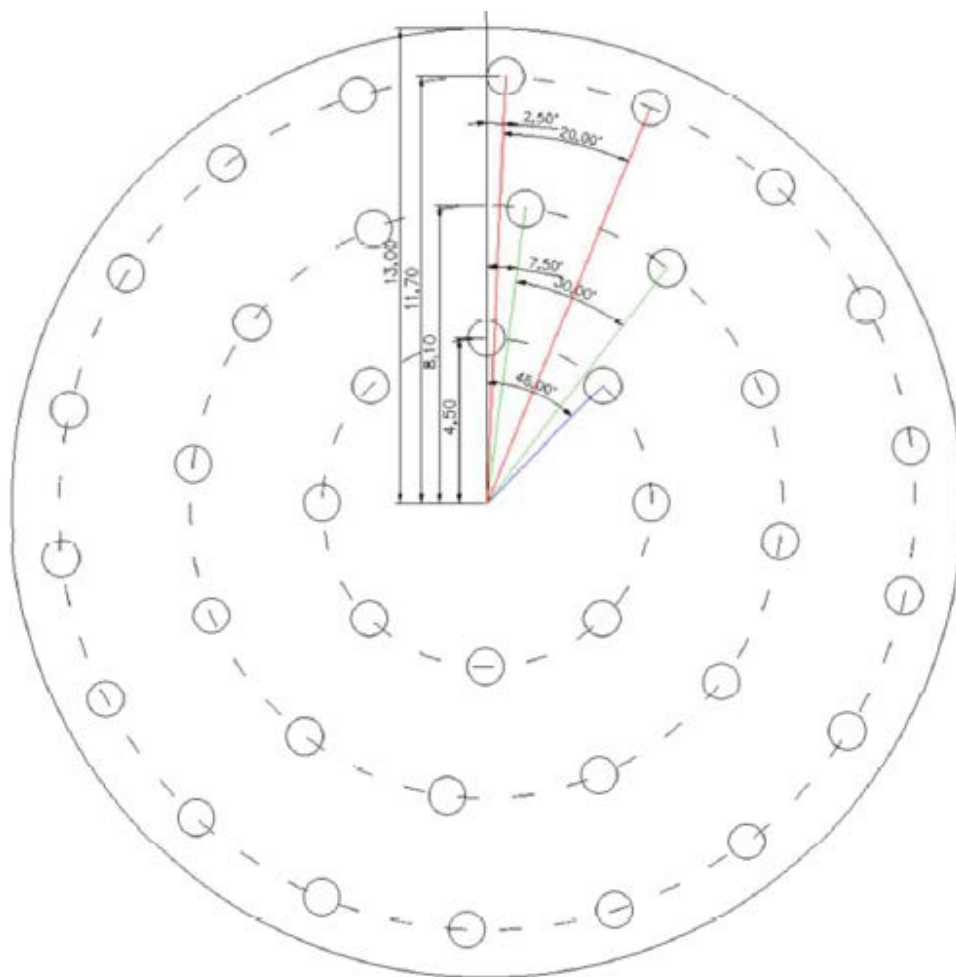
Pianta del Plinto di fondazione degli aerogeneratori con disposizione radiale dei 38 pali trivellati
